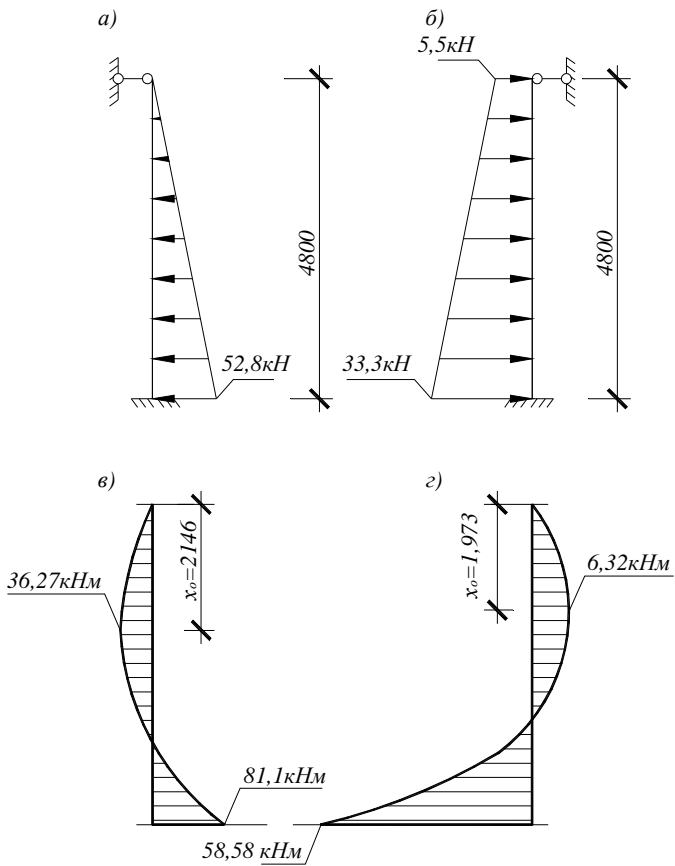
Расчетные схемы и эпюры моментов в стенке резервуара:
